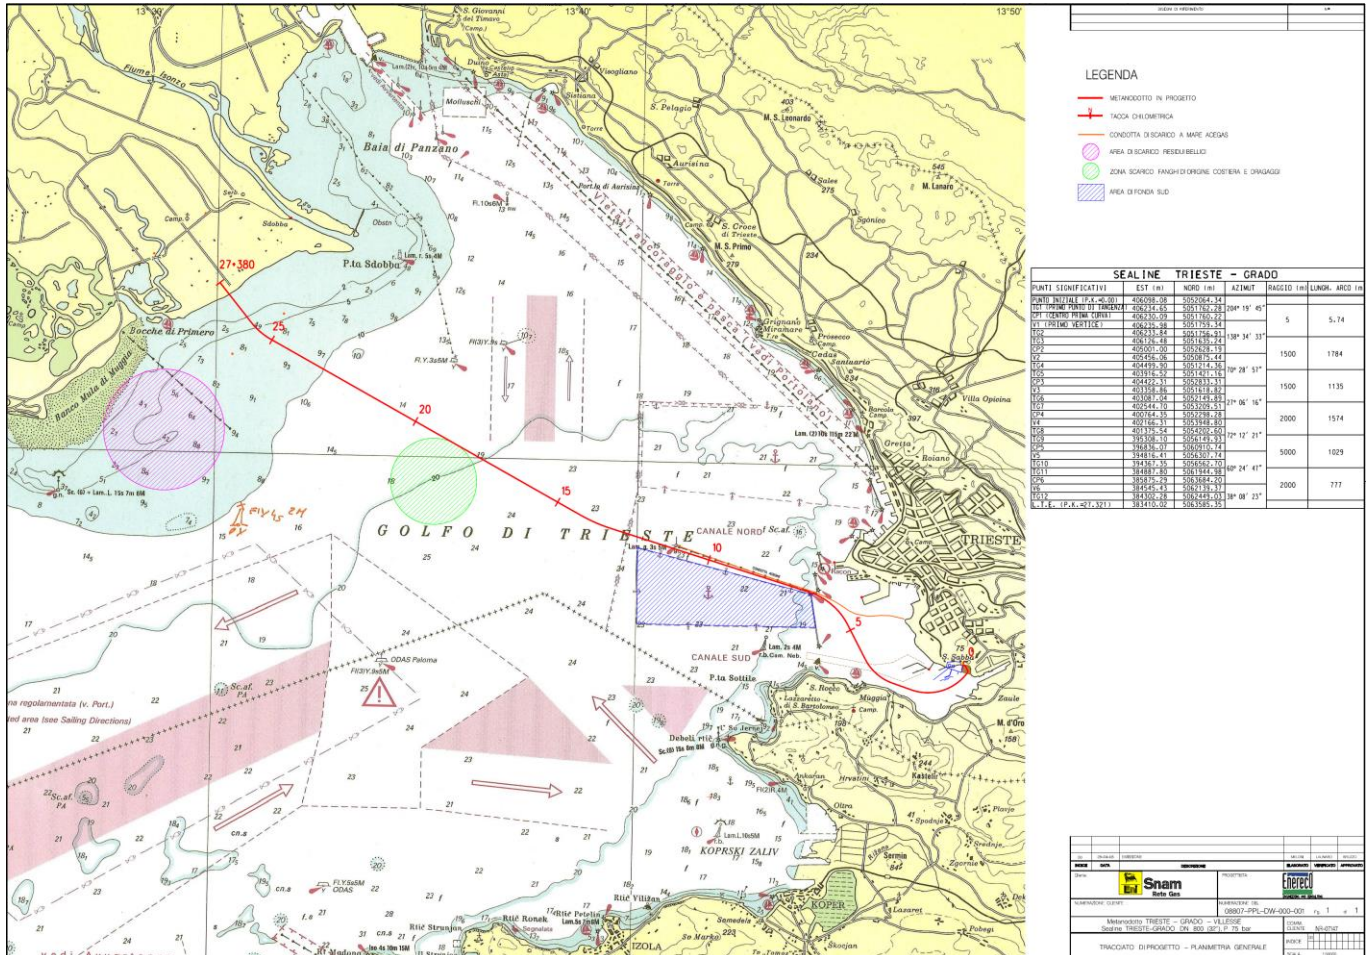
PLANIMETRIA GENERALE DEL TRACCIATO DI PROGETTO
